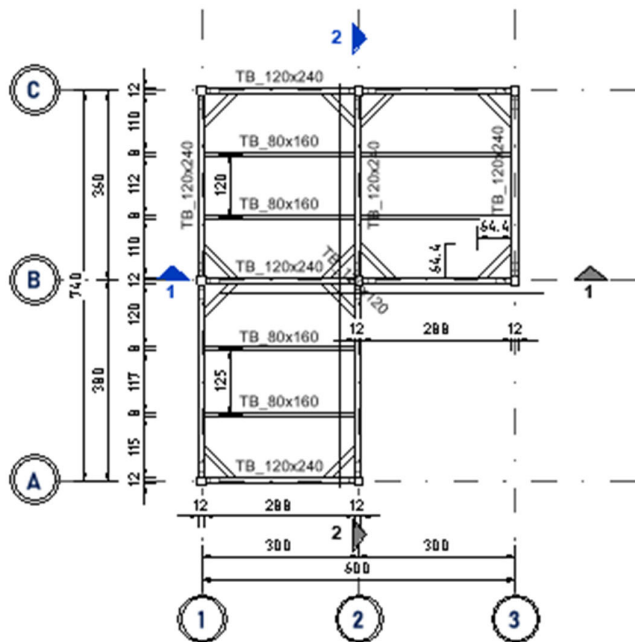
Planimetria e ures, dhe prerjet kryesore.
